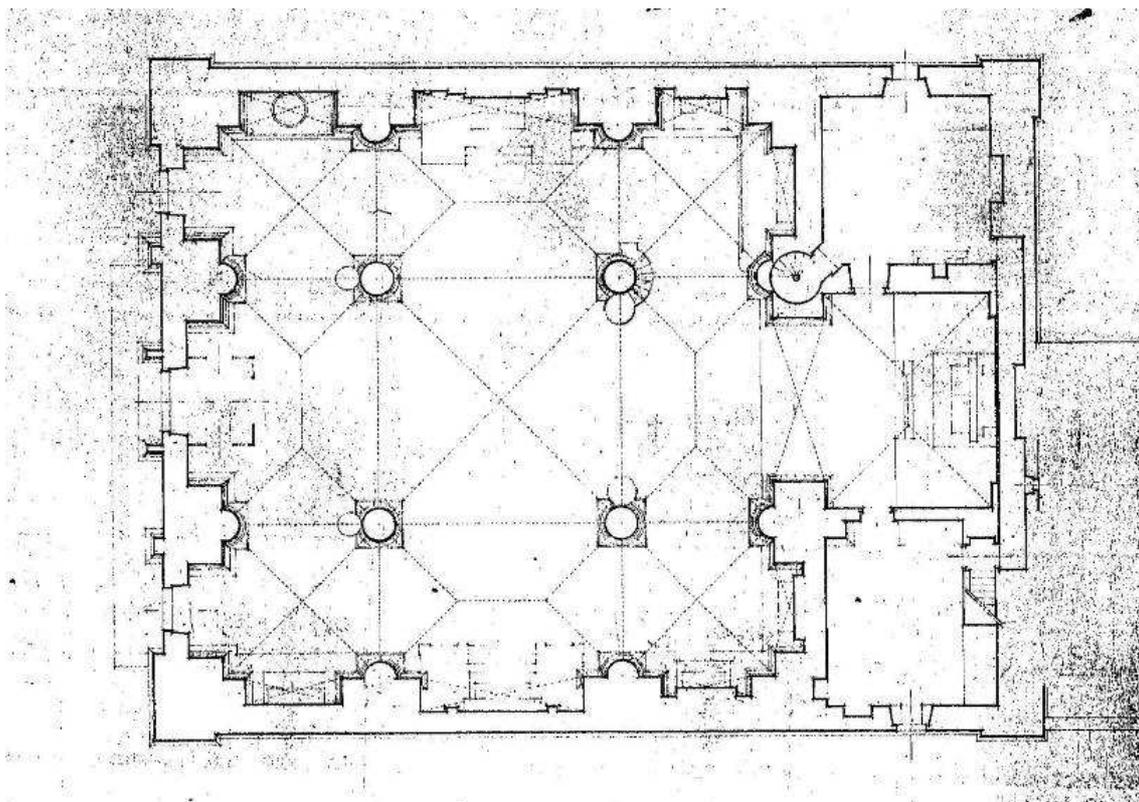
Planta da Igreja de Santa Maria de Estremoz.
